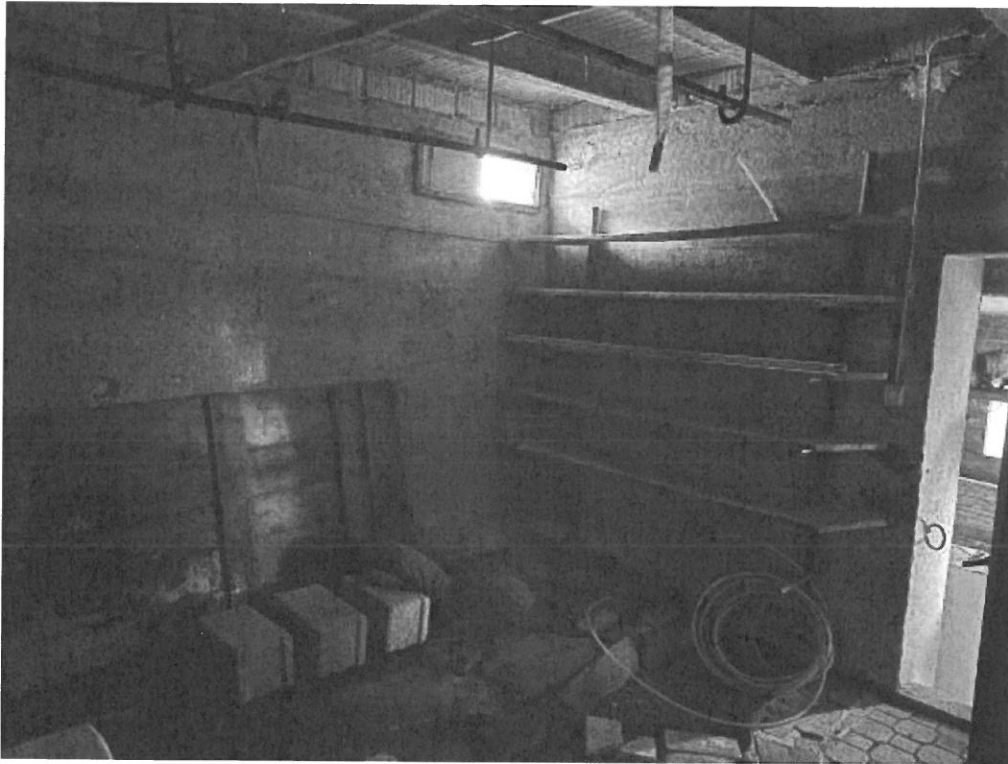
PS1 (sub. 3) deposito angolo Ovest
